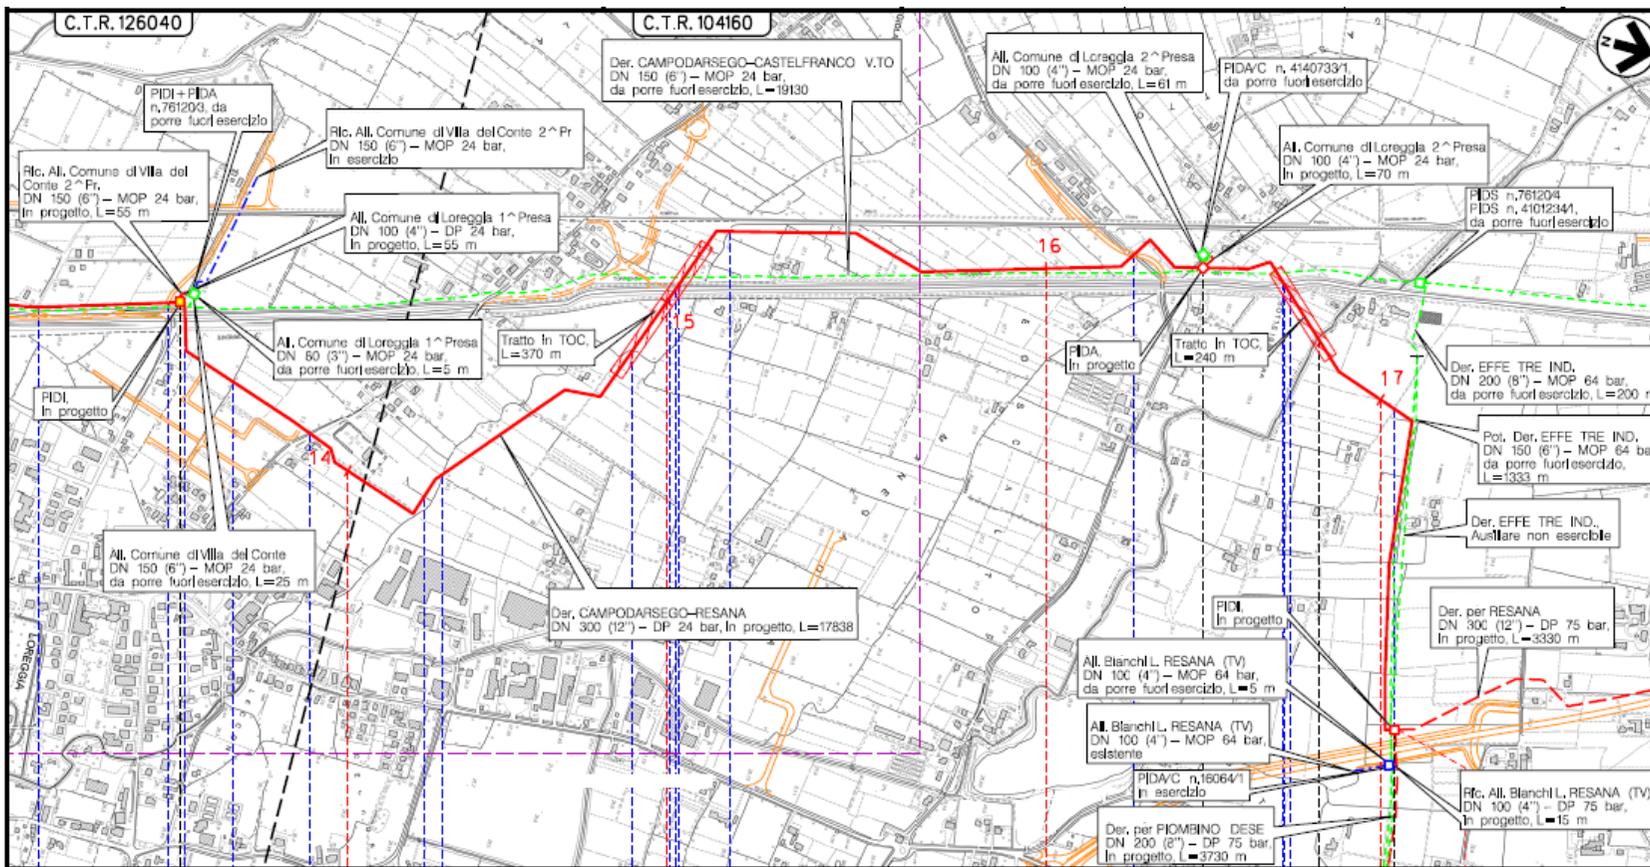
1^a TRATTO - Stralcio planimetria CTR con localizzazione dell'area di intervento
